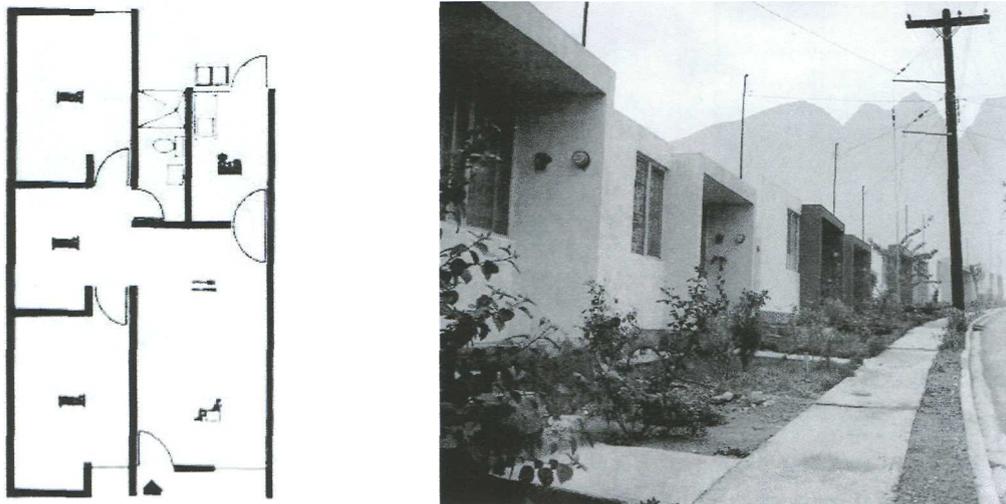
Planta tipo e imagen exterior original de viviendas en el fraccionamiento Valle INFONAVIT V.
